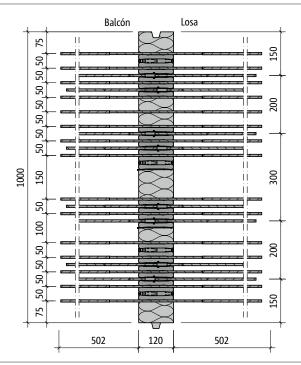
Schöck Isokorb® XT tipo K-M5-VV1: Plano del producto
